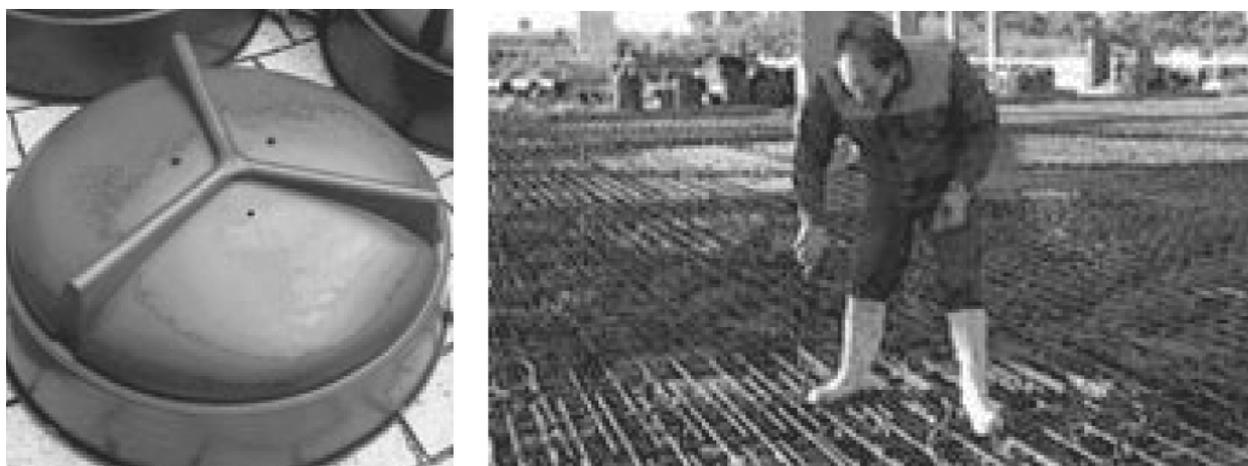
Контроль заполнения бетонной смесью нижней зоны плиты перекрытия с пустотами в виде перевернутых колпаков
